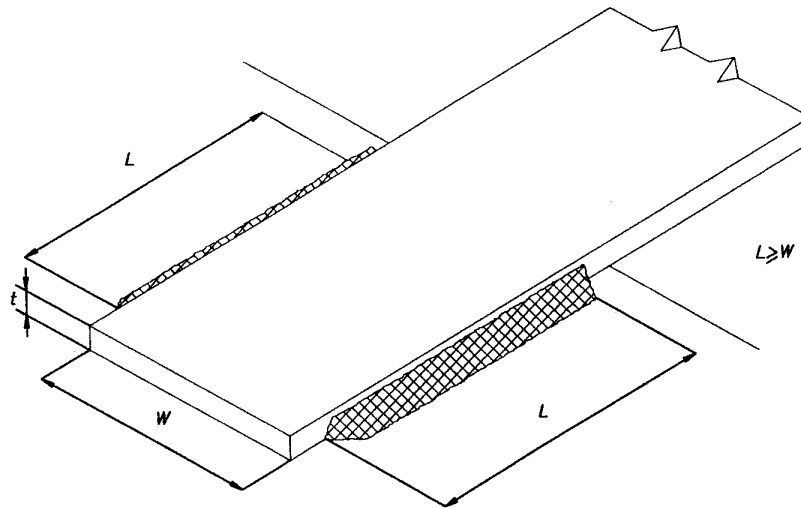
Soldadura a filete longitudinal.
